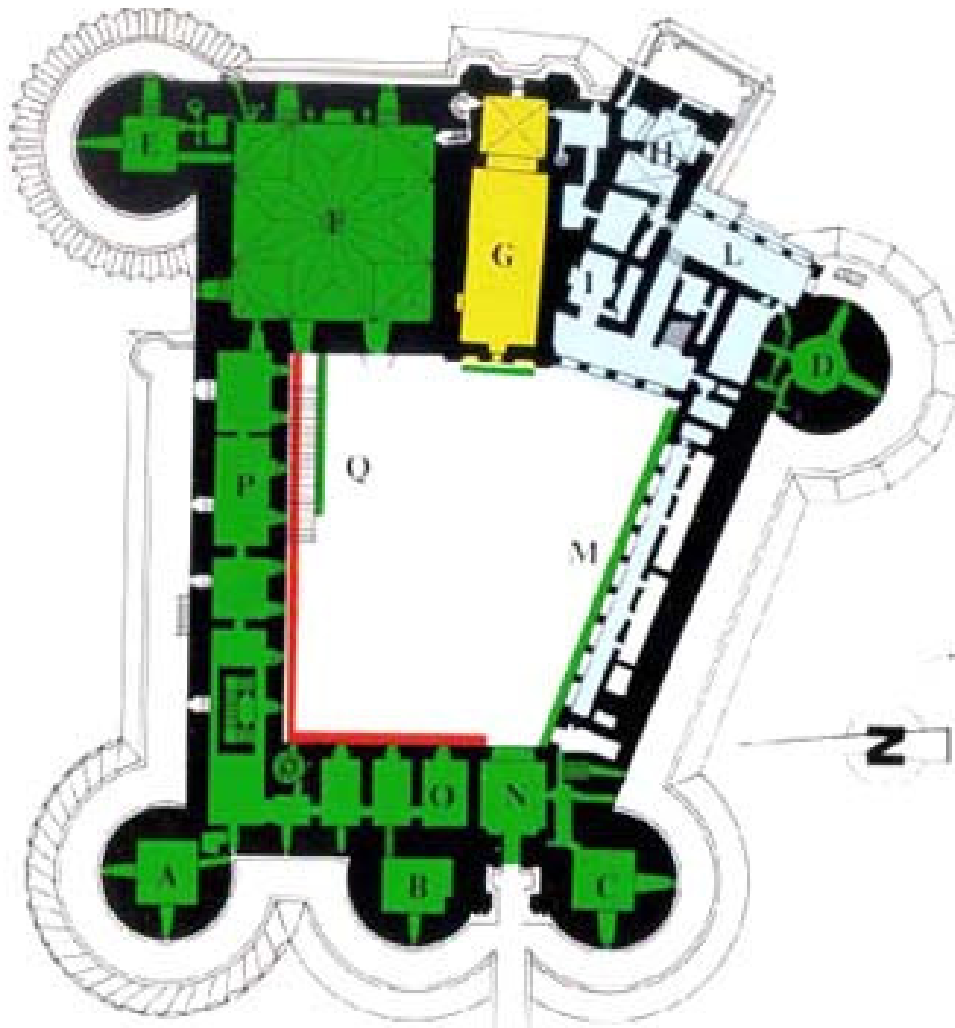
Schema planimetrico Castel Nuovo Napoli
